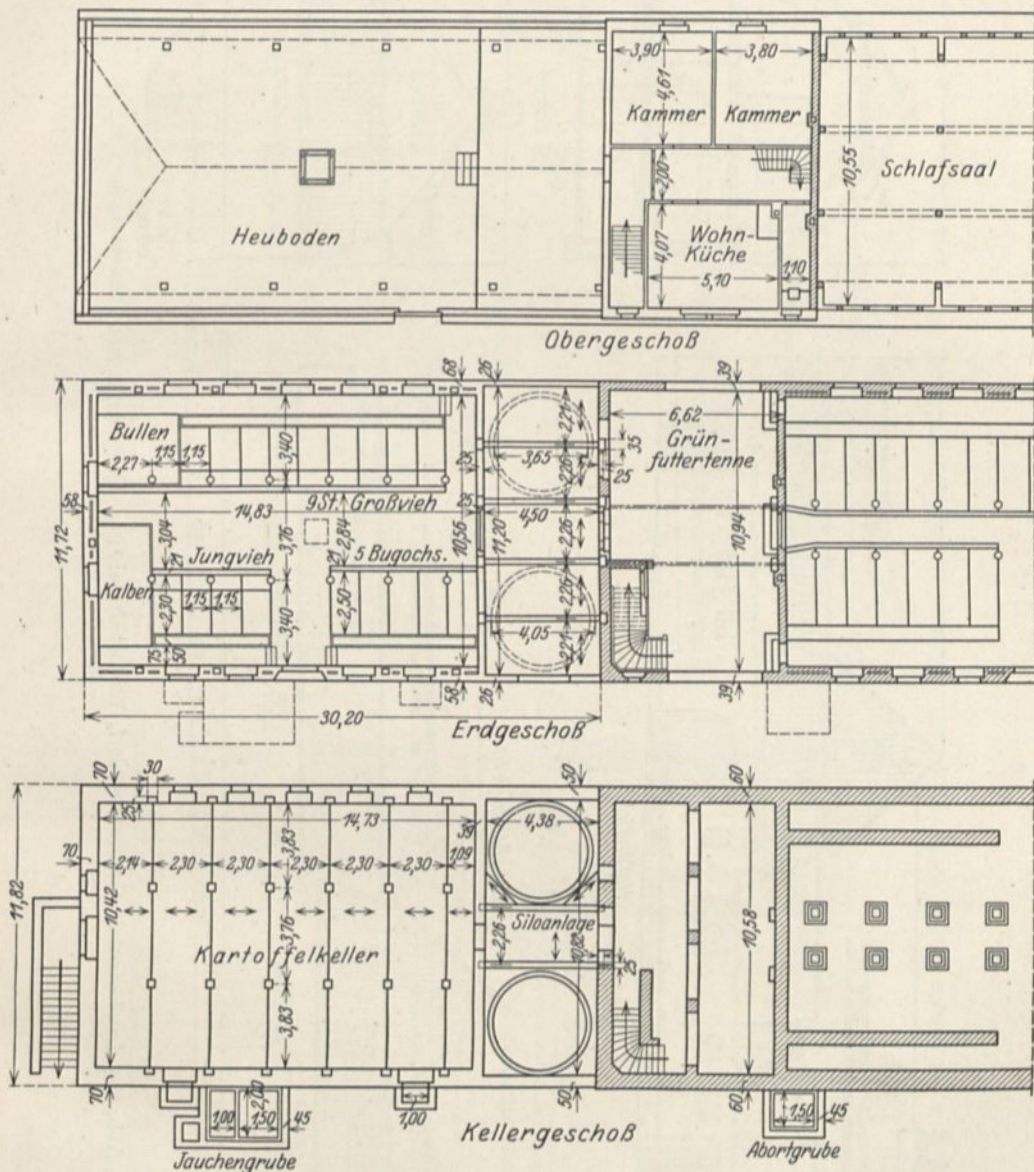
Landesanstalt Großhennersdorf. Erweiterung des Wirtschaftsgebäudes der Meierei. Grundrisse. (Ausführung: Walter Rüde, Dresden.)
